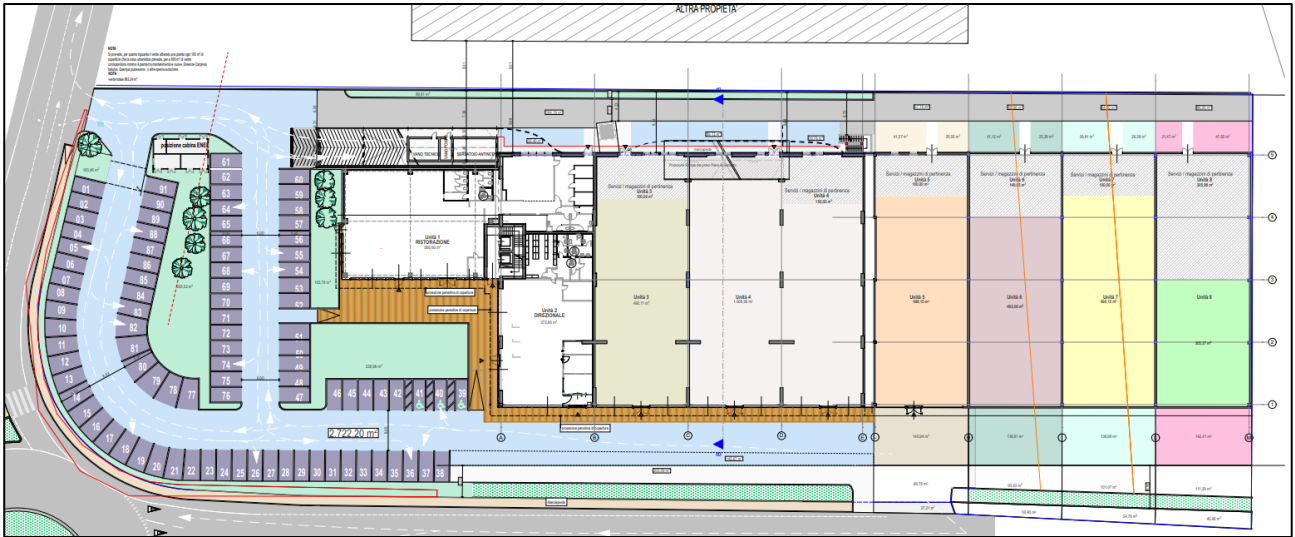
Planimetria di progetto del piano terra del fabbricato.
